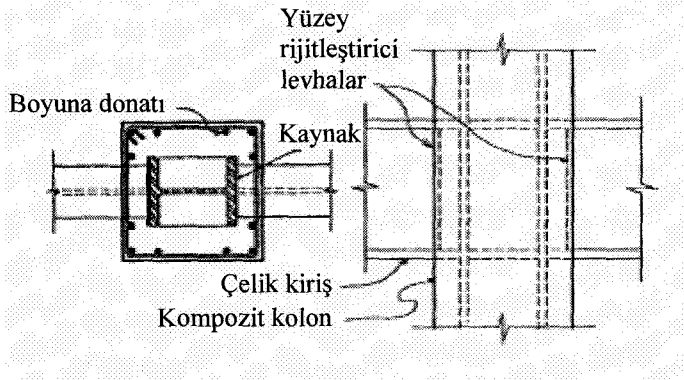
Betonarme kolon-çelik kiriş moment bağlantısı [7]
